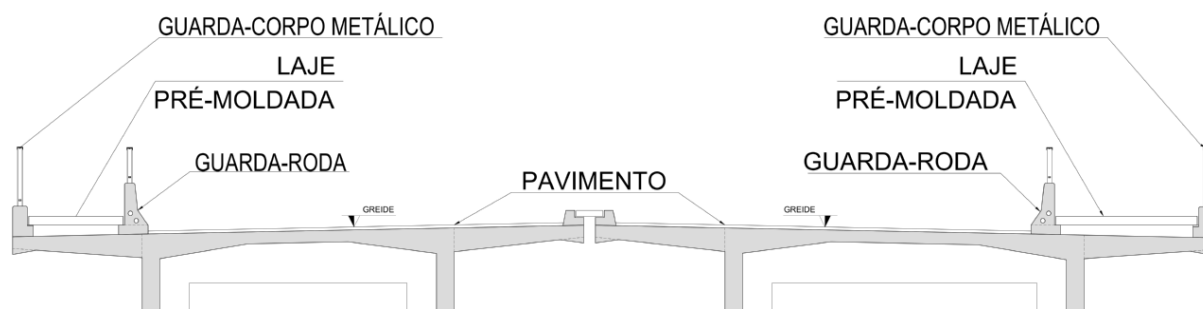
ELEMENTOS - CARGA PERMANENTE - ENCONTROS ESTRUTURADOS
